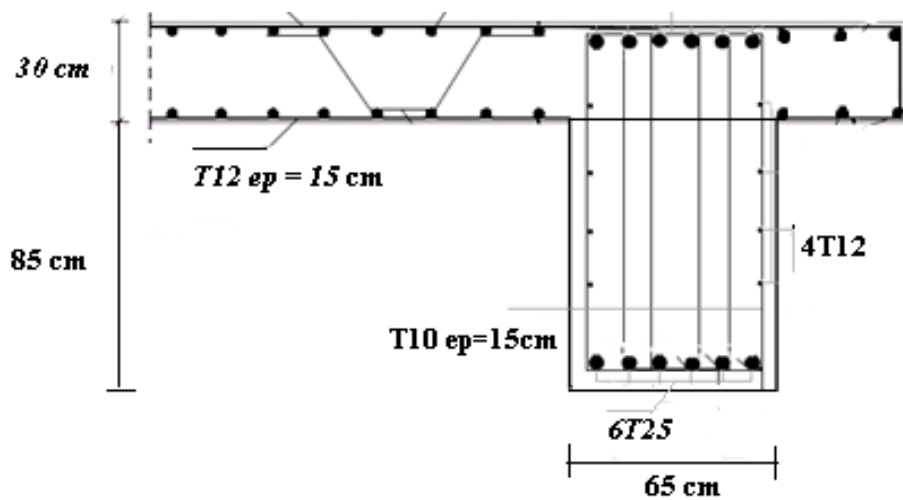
Ferrailage du radier, nervure, voile périphérique et débord sur une coupe en travée.
